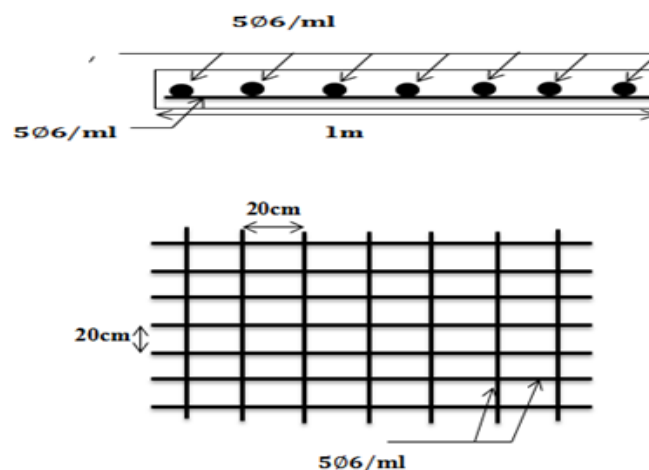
Disposition constructive des armatures de la dalle de compression
